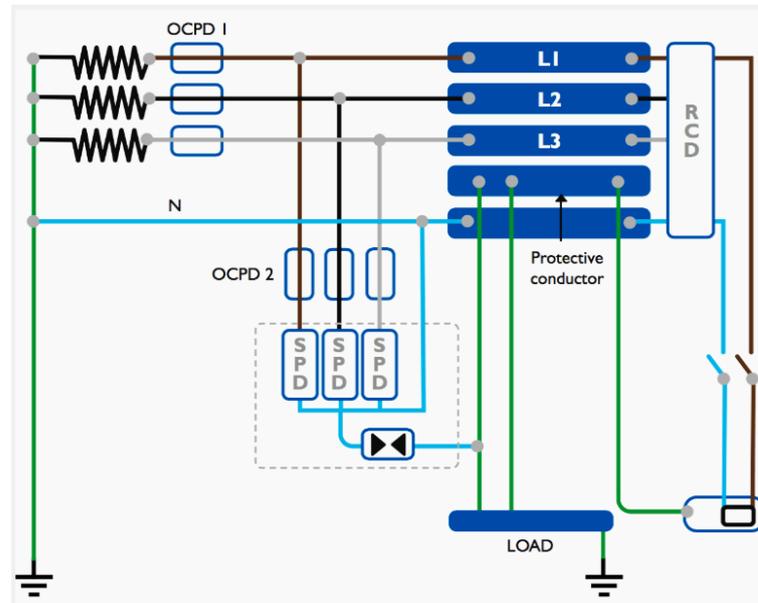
Protección contra sobretensiones, conexión SPD tipo 2 (CT1)
